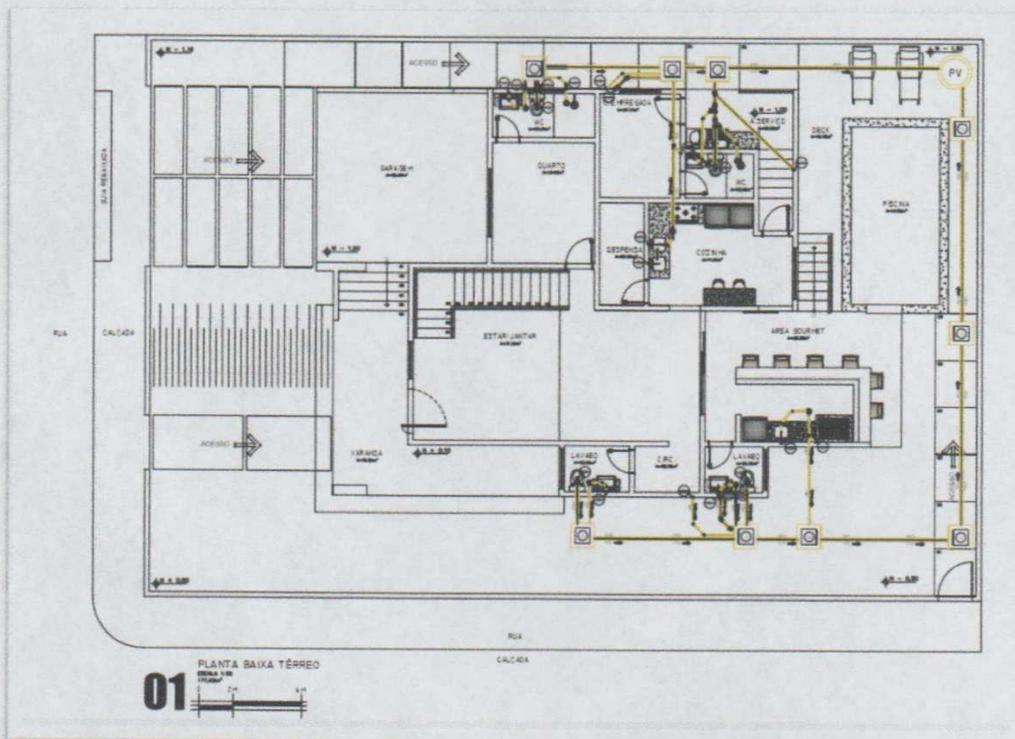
Planta baixa Térreo Instalação predial de tubulação de esgoto.
